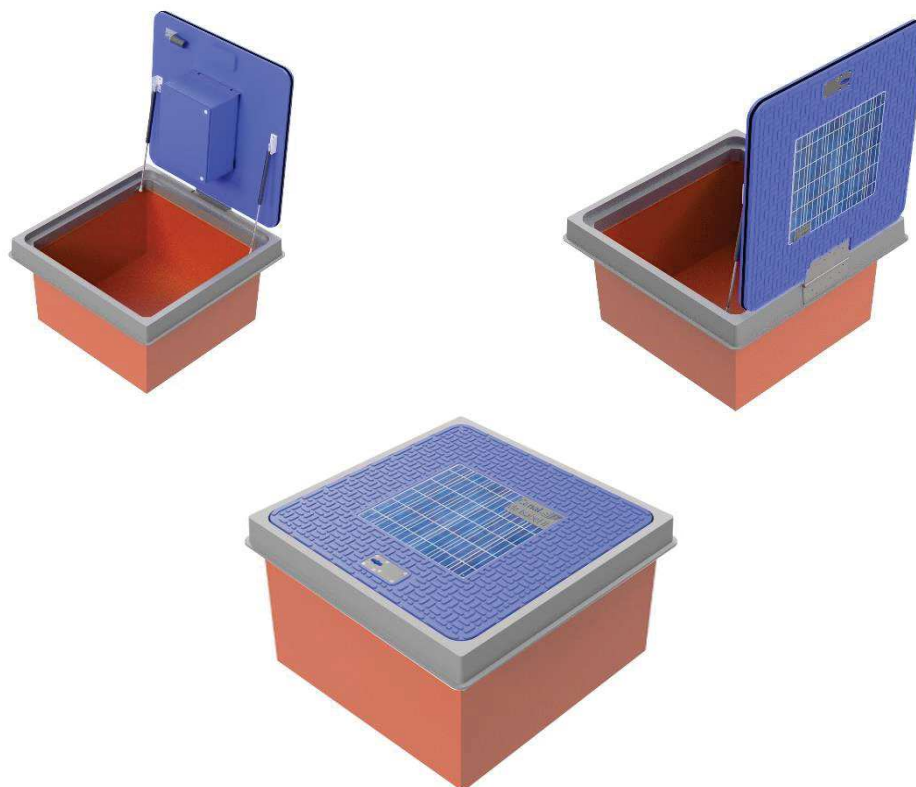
Detalle tapa y cajón tipo con cuadro de Telemetría instalado
